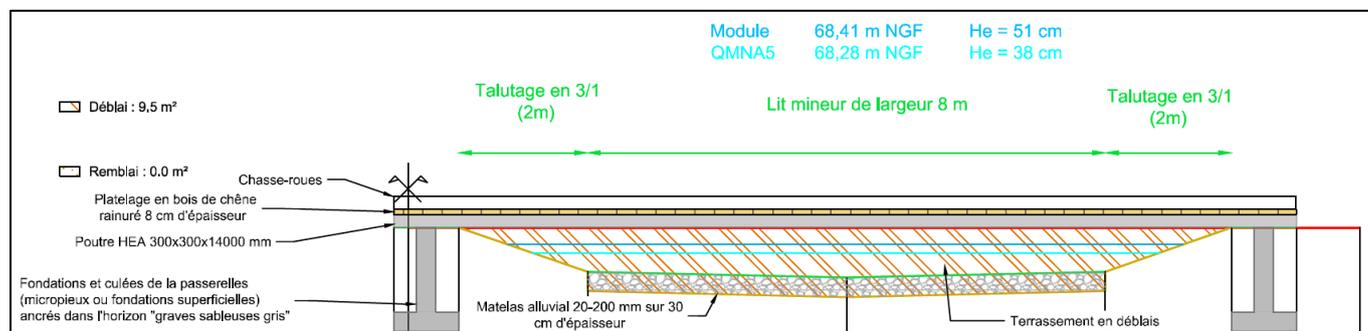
Profil en travers au droit du pont agricole (PT7)
